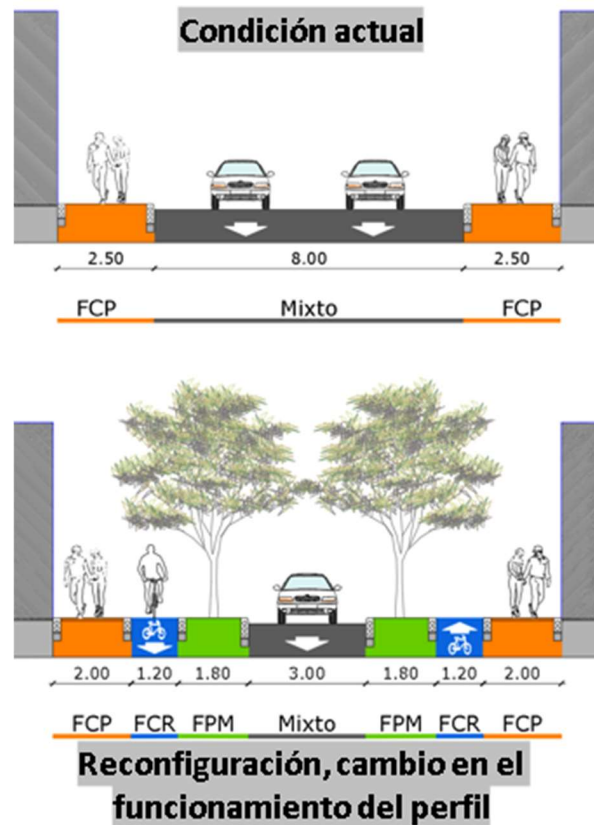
Ejemplo de Reconfiguración de tipo de calle en sección transversal
